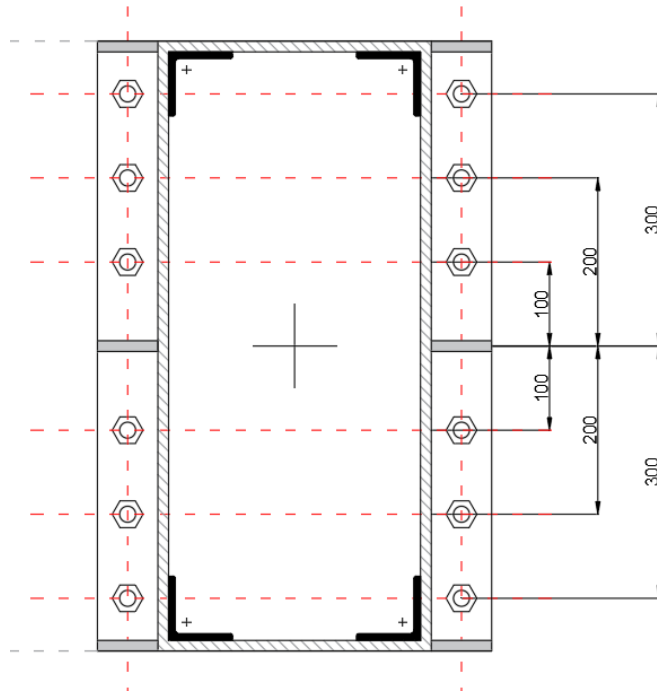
Corte transversal y detalle del empalme viga – viga
